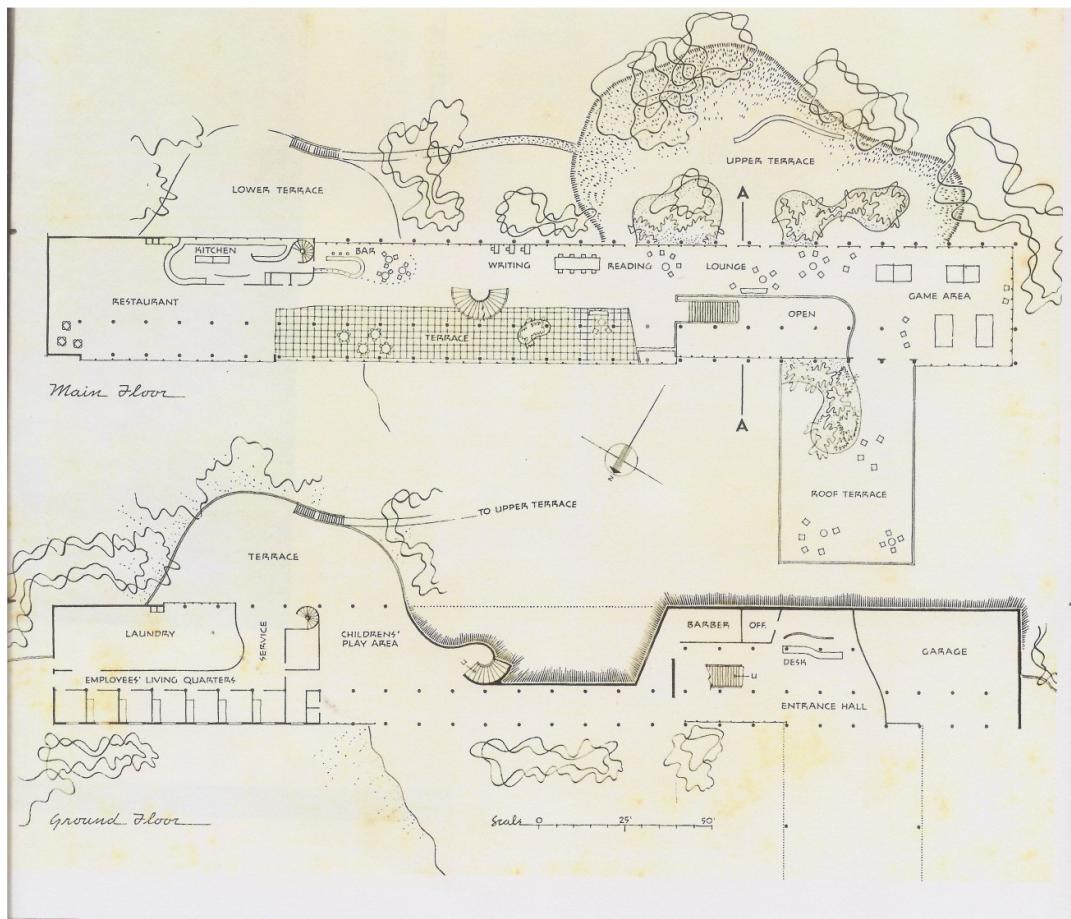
D- Plantas baixas dos pavimentos térreo e primeiro
